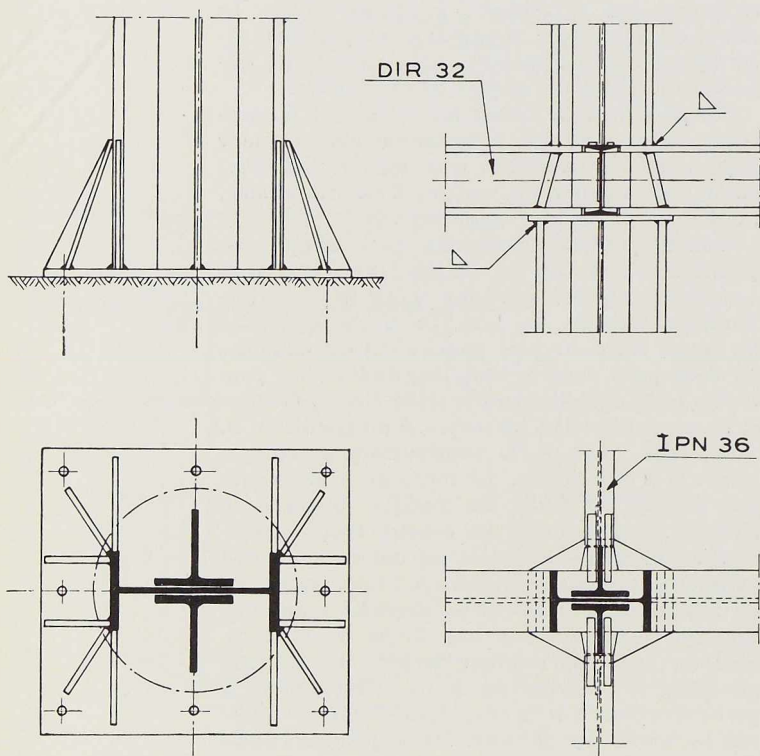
Détails constructifs. A gauche, pied de la colonne; à droite, assemblage poutre principale-colonne.
